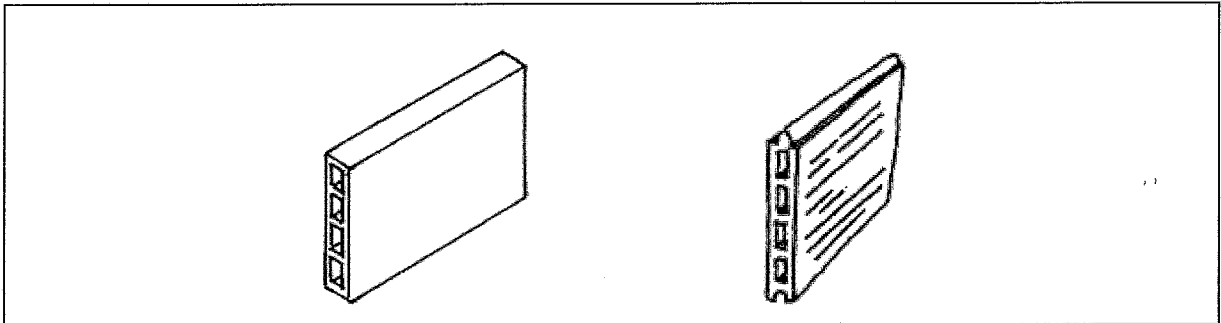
Pormenor de peças de tijolo furado para realização de forras cerâmicas simples [4]
